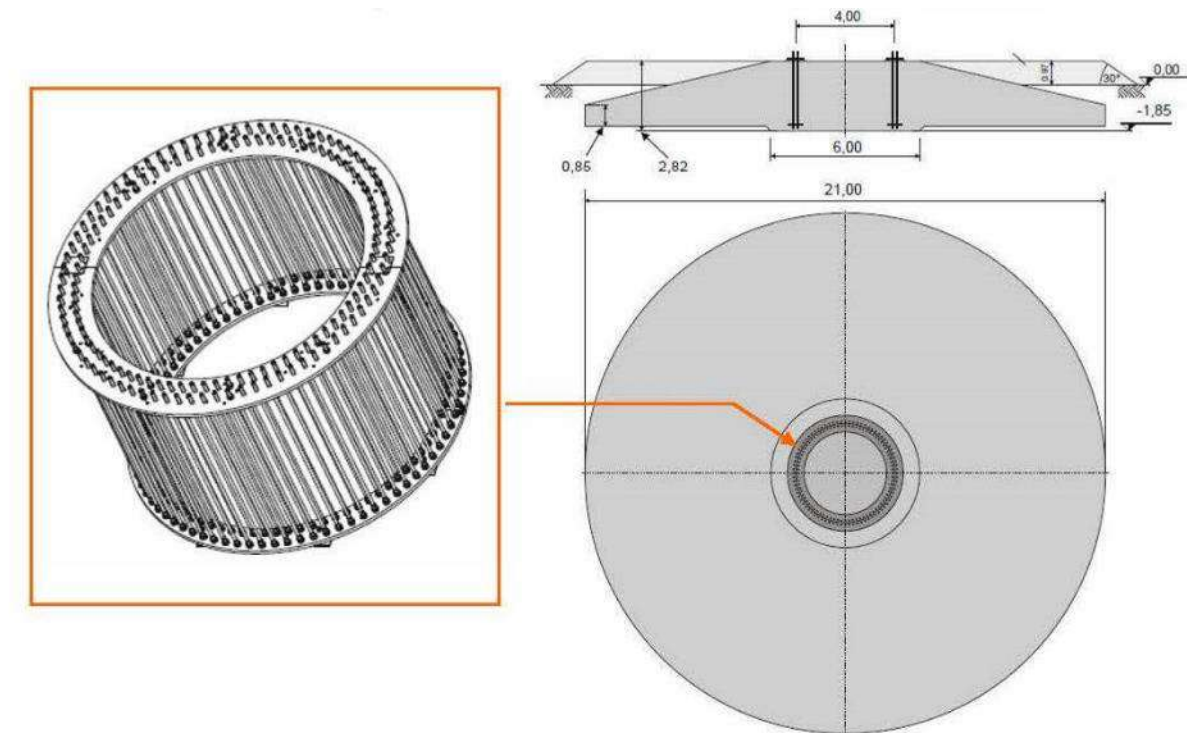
Schéma d'une fondation et de l'« anchor cage » (Source : NORDEX)
